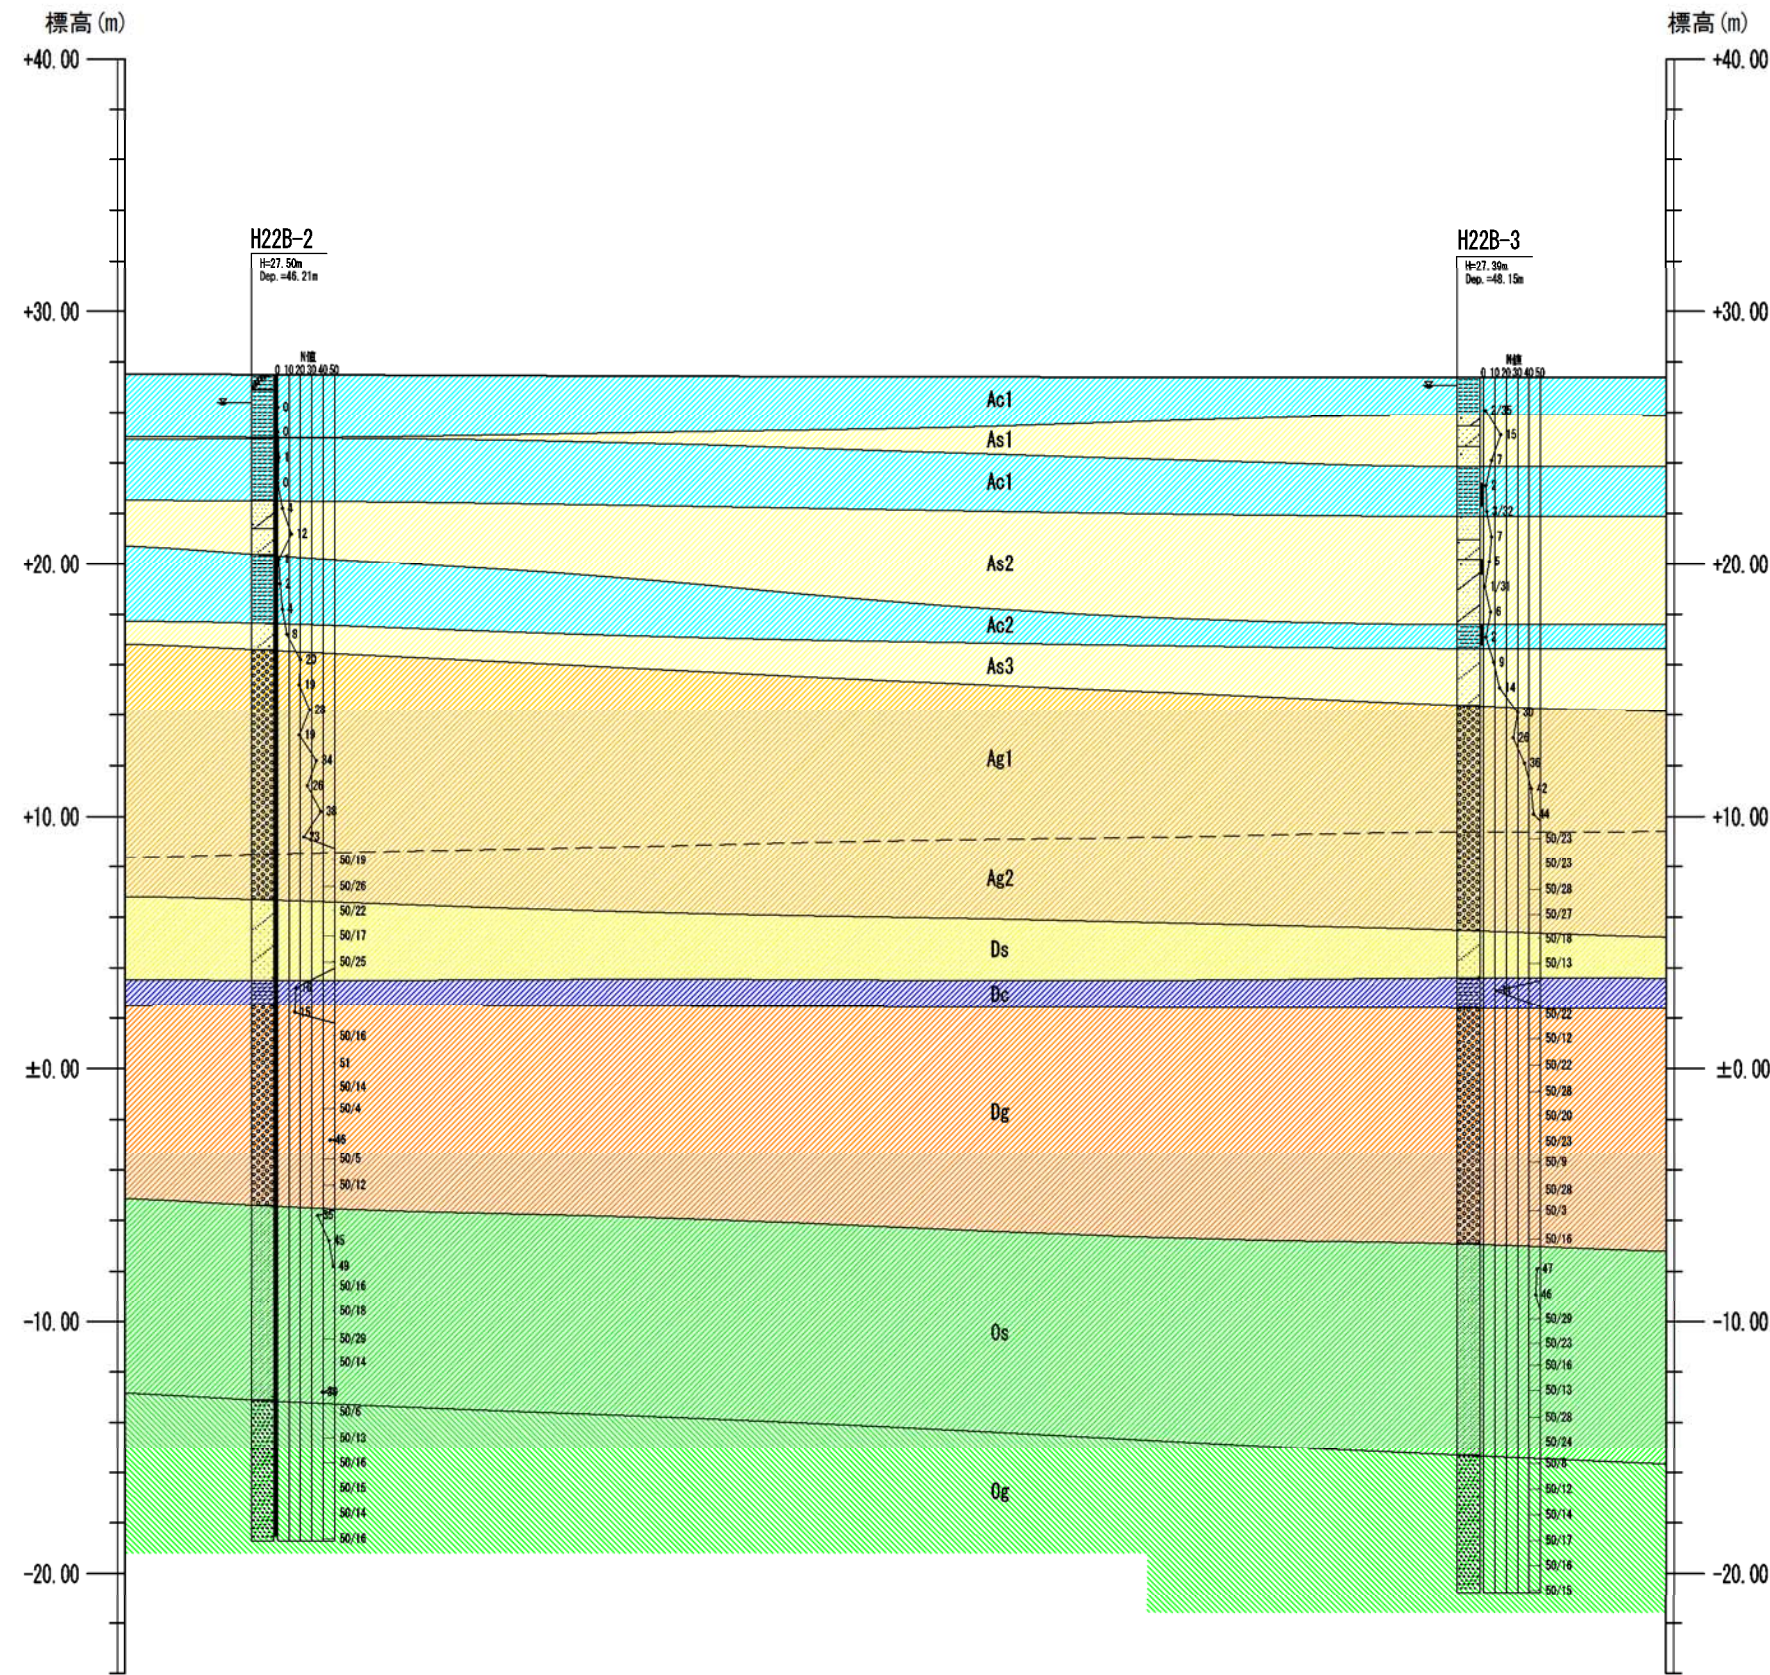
地質推定断面図 (A-A' 断面, 縮尺 縦 1/300 横 1/600)
